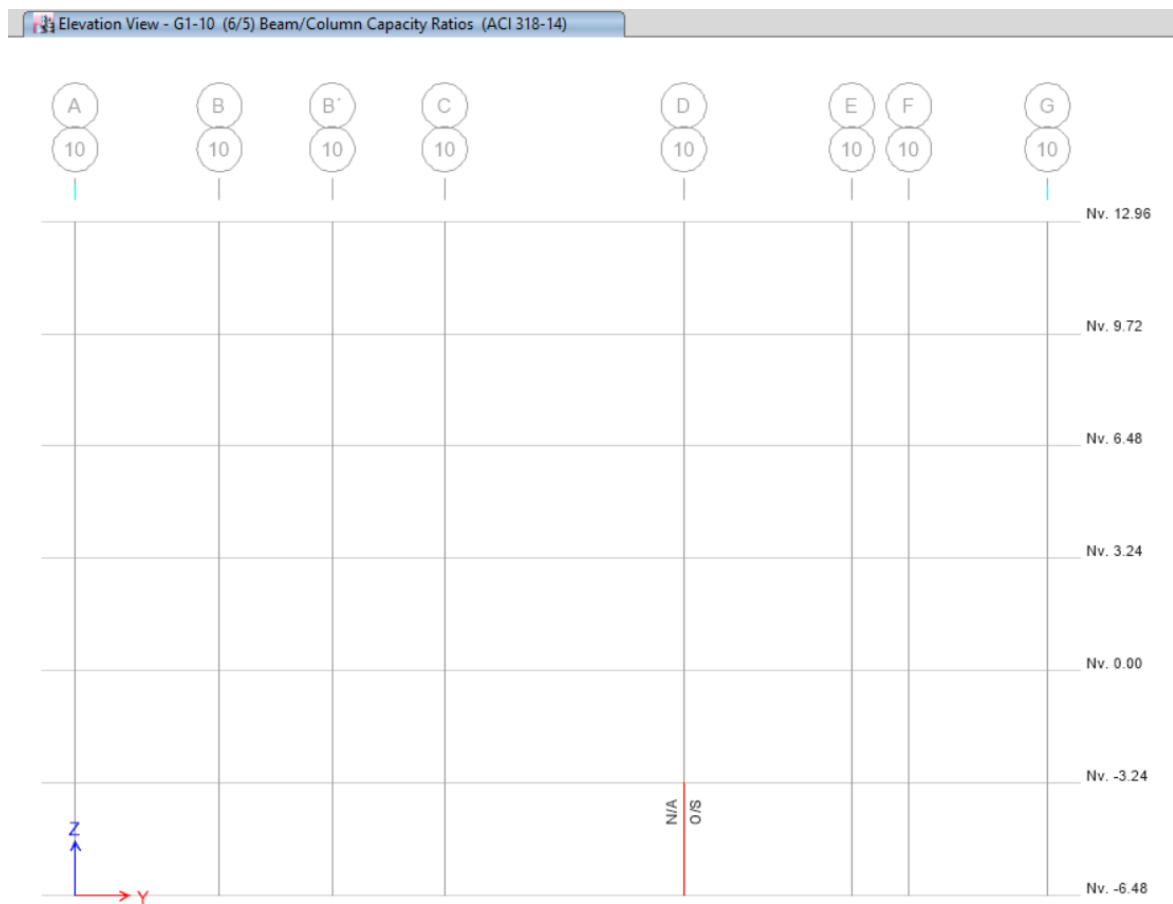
Vista en elevación de factor de capacidad unión viga-columnas, pórtico eje 9.
